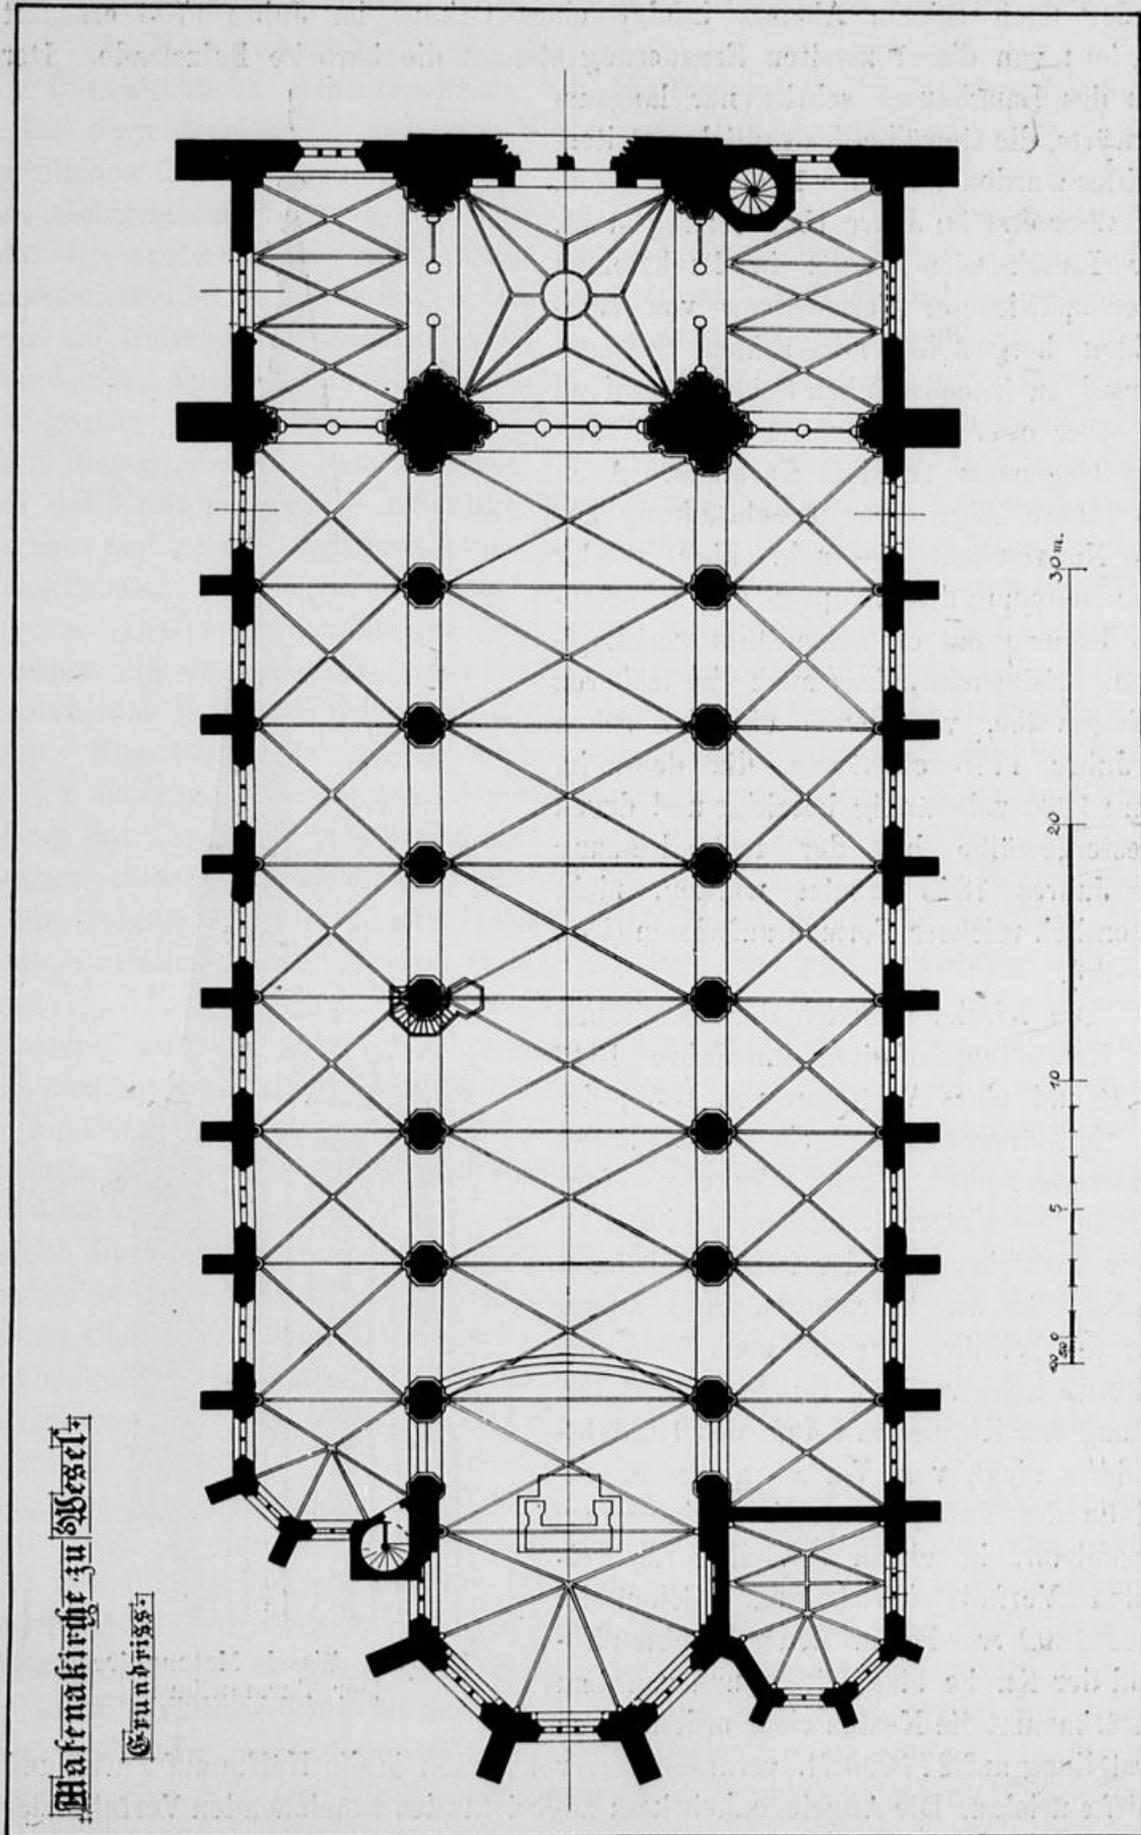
Wesel, Matenakirche. Grundriss.
